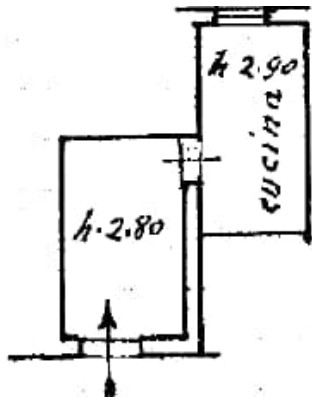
Planimetria catastale d'impianto (12.12.1939).
